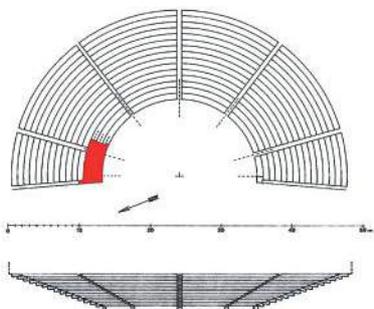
Ipotesi ricostruttiva della planimetria e della sezione dell'alzato dell'edificio (da F. Martorano)
